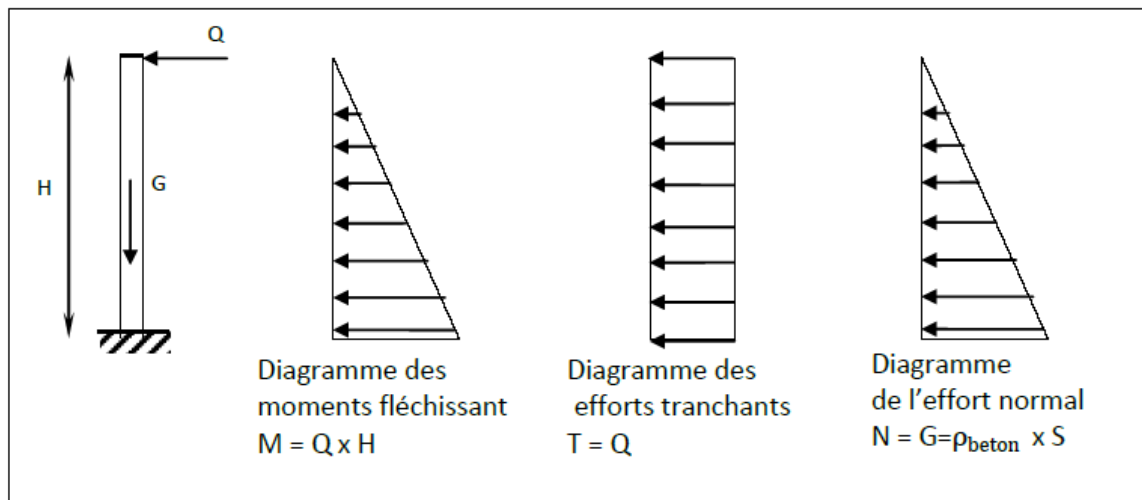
Coupe verticale et schéma statique de l'acrotère.
